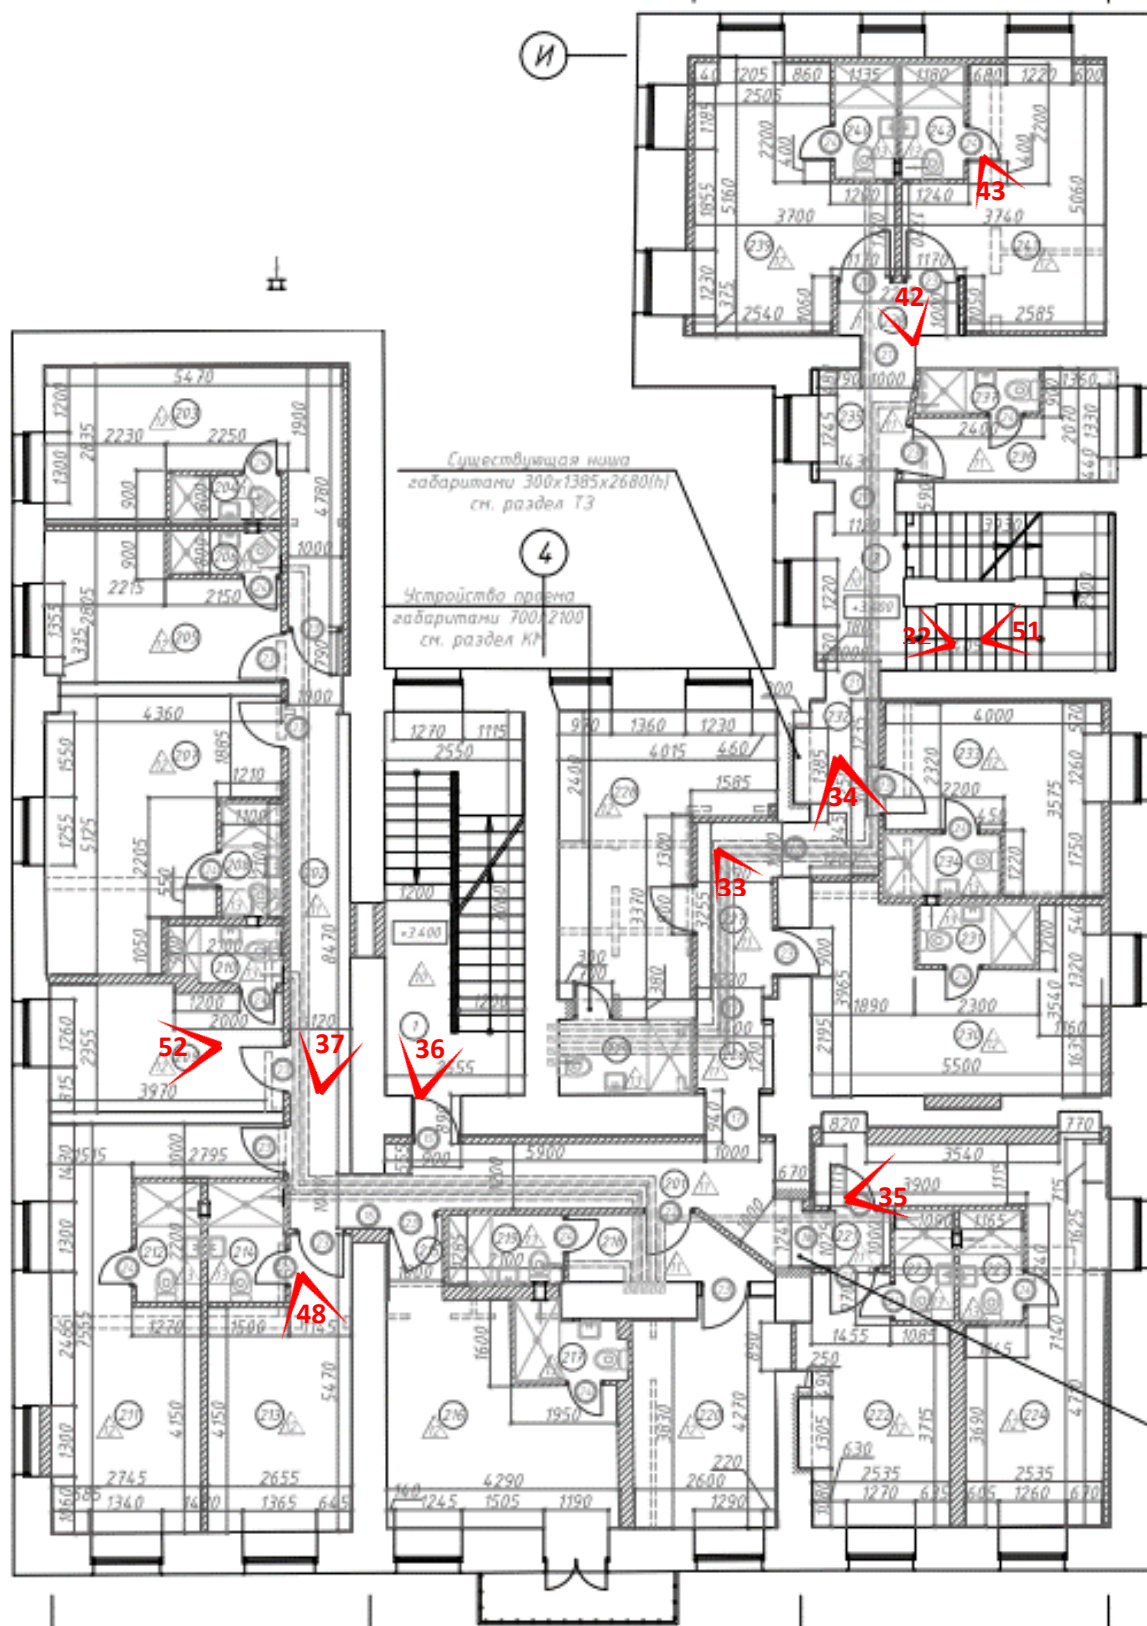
Схема фотофиксации на плане помещений, 2 этаж
